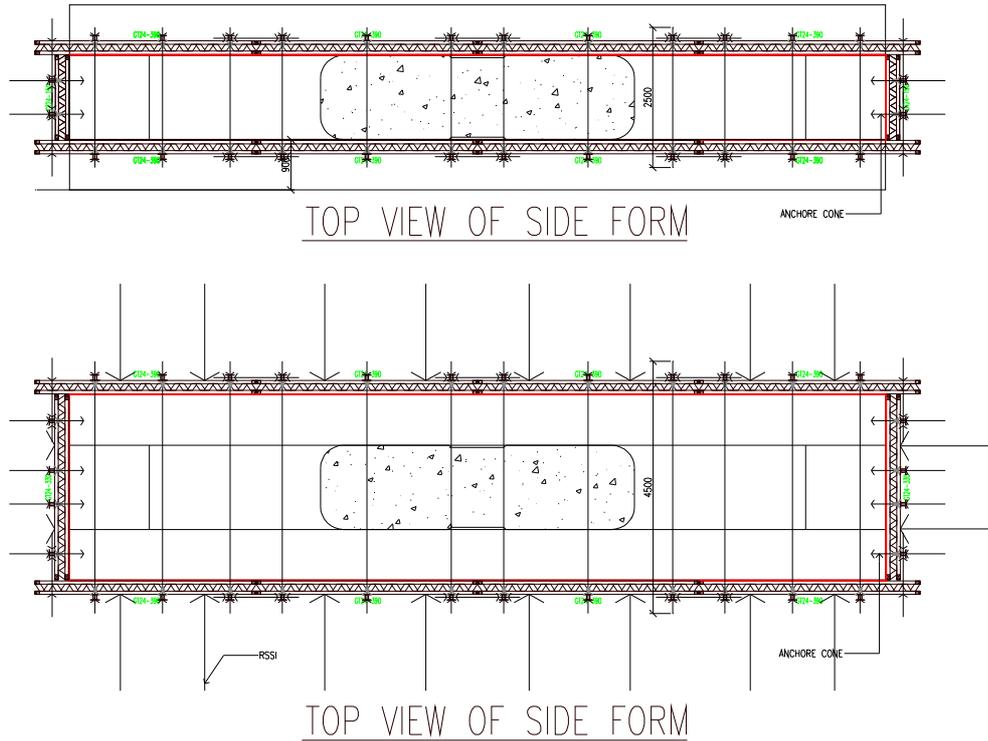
Potongan A dan B Formwork Pier Tahap-3 (Pier Head)
